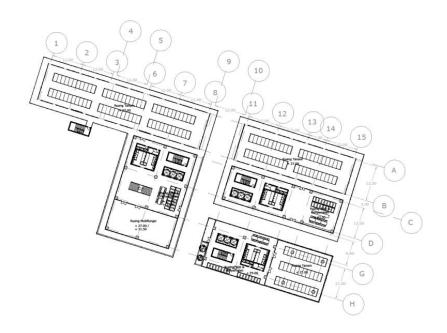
(e) Denah Lantai 4 dan 5 Tipikal
